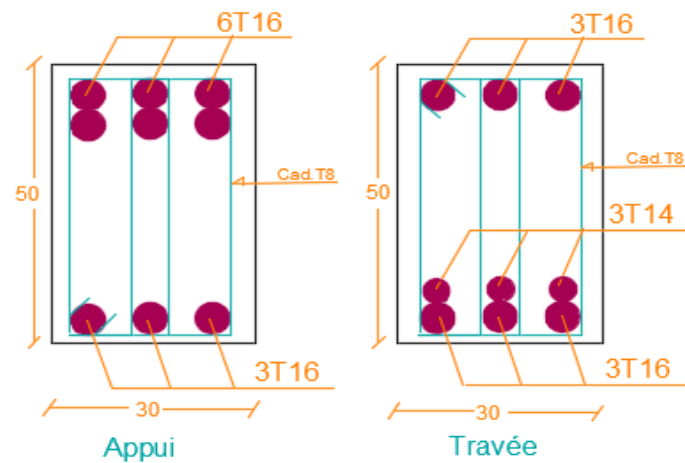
Ferrailage Des Poutres Porteuses Axes (C-D) Des étages courants.
